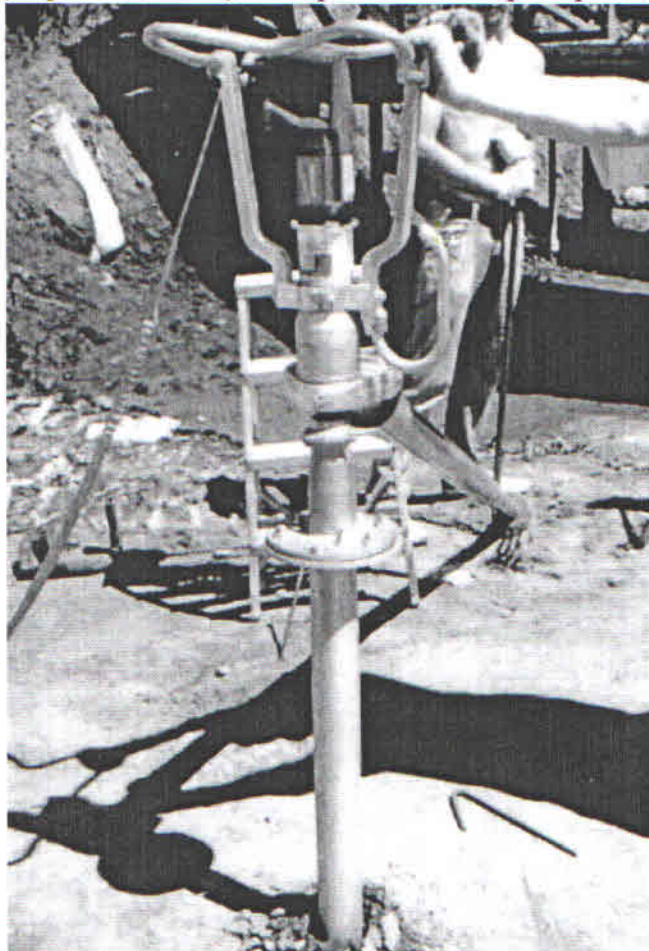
Погружение свай «KRINNER» в грунт на экспериментальных площадках
